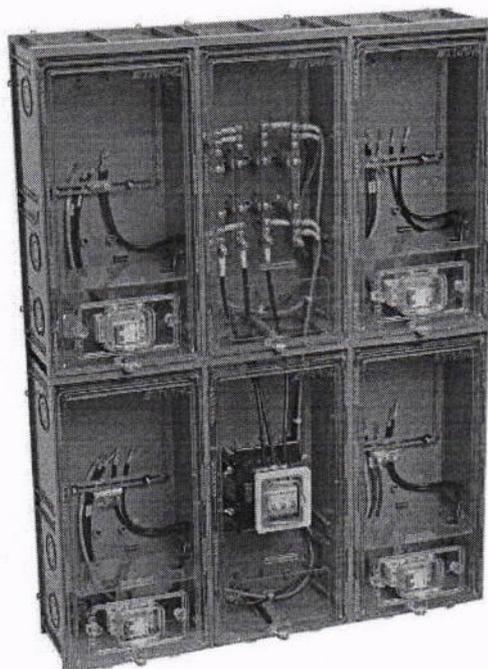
Modelo de quadro a ser instalado - Praça do Povo.
